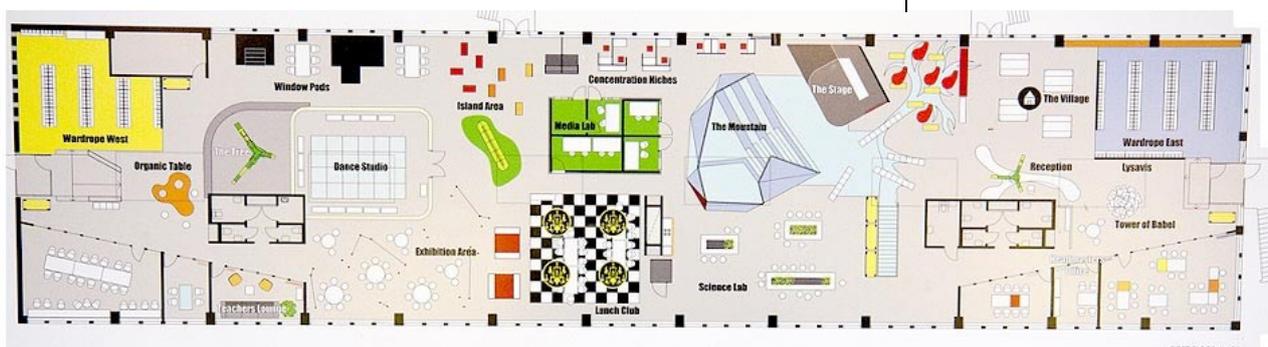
La pianta "libera" senza pareti divisorie della scuola "TelefonPlan" Stoccolma, Svezia.
